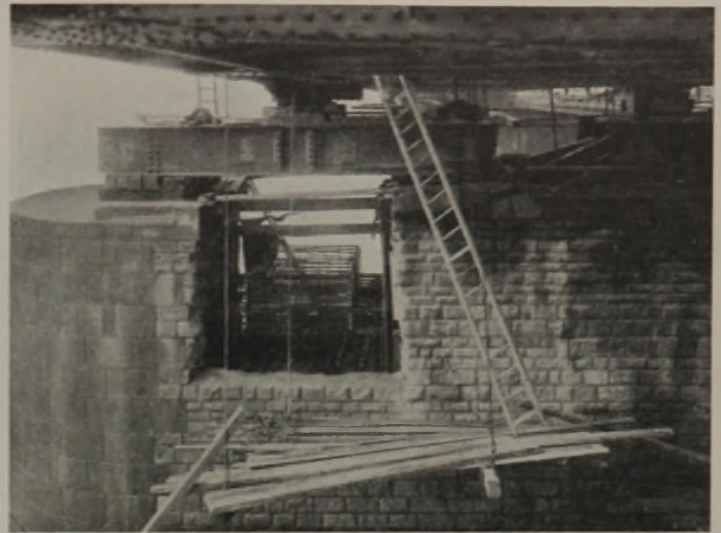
Abfangung der neuen Hauptträger zwecks Herstellung der Eisenbetonbänke.
